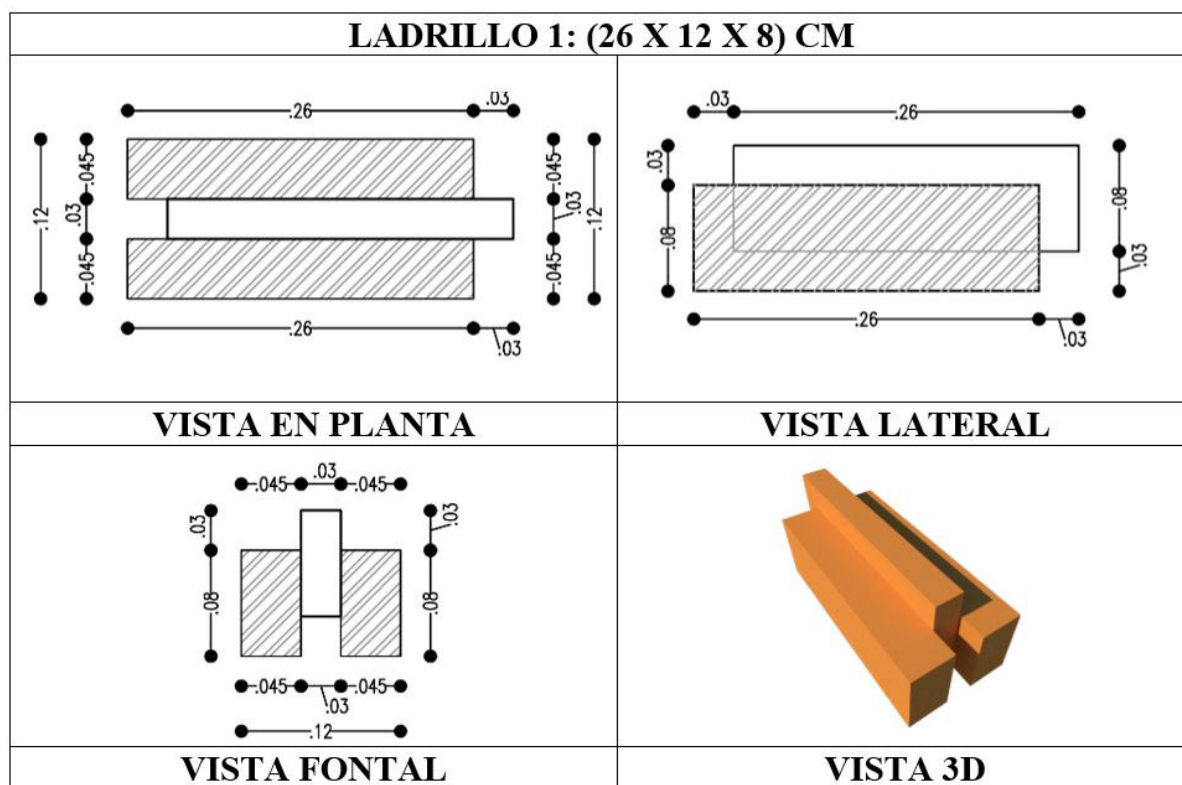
Medidas de ladrillo PET N° 1, Fuente: Autor
